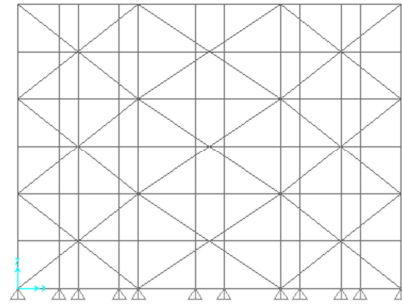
Configuração dos Planos de Contraventamento Vertical Com Elementos de Contraventamento Grandes
